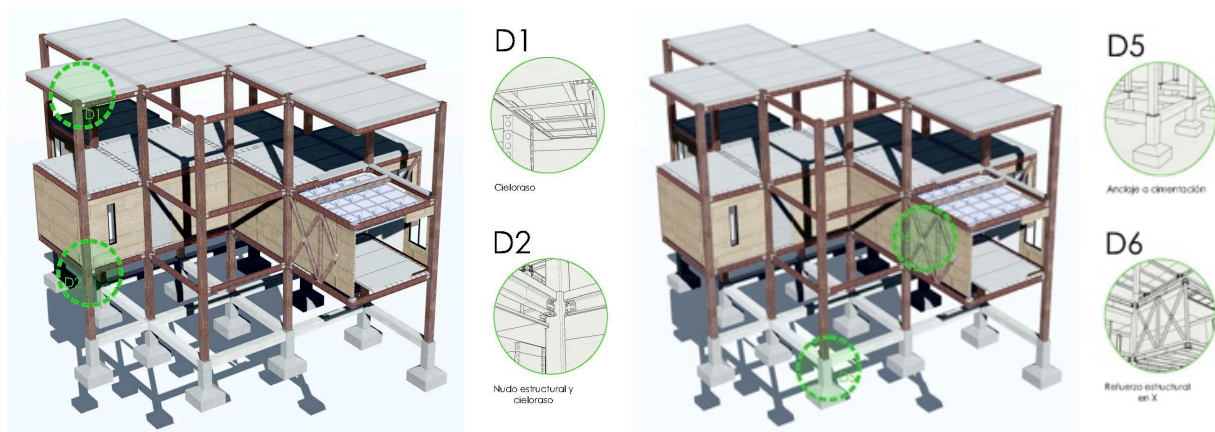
Esquemas estructurales en donde se pueden observar los detalles de las uniones en la estructura como también los elementos de refuerzo estructural (Elaboración del autor)
